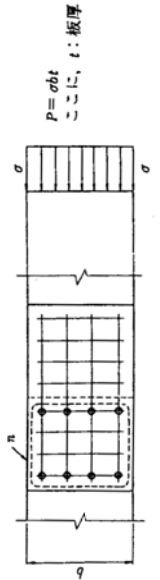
ボルトに作用する力 (垂直応力の分布が均等な場合)
